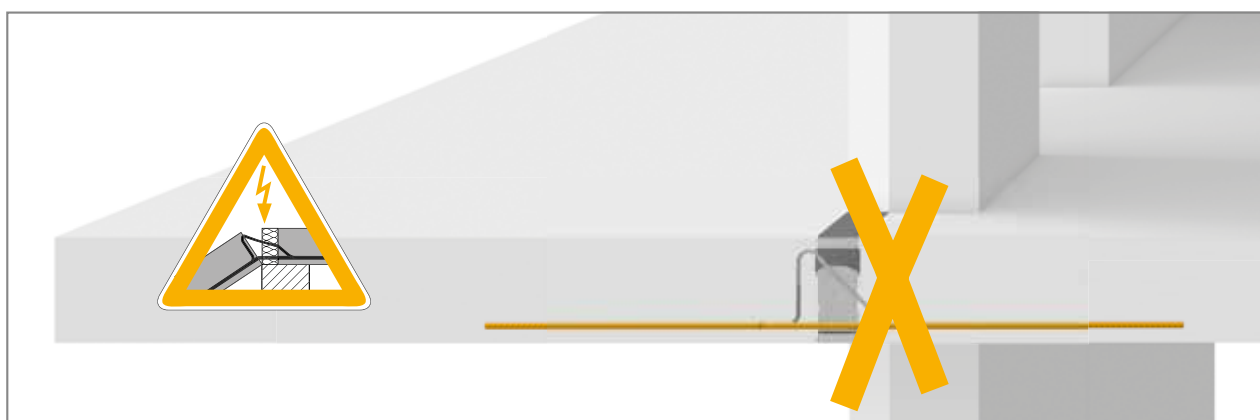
Schöck Isokorb® tipo K, se montato non correttamente la barra tesa sta sotto
